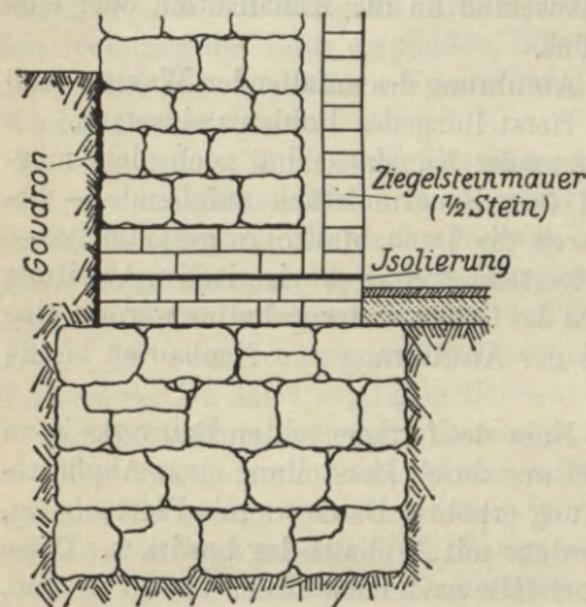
Isolierung und Anordnung einer Luftschicht bei Bruchsteinmauerwerk.
